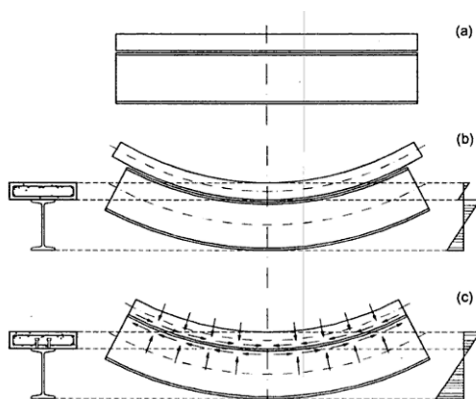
Comparación de tensiones en una viga independiente y una viga mixta
